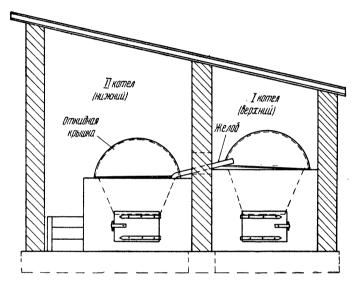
Поперечный разрез типовой двухкотельной битумоварочной установки
